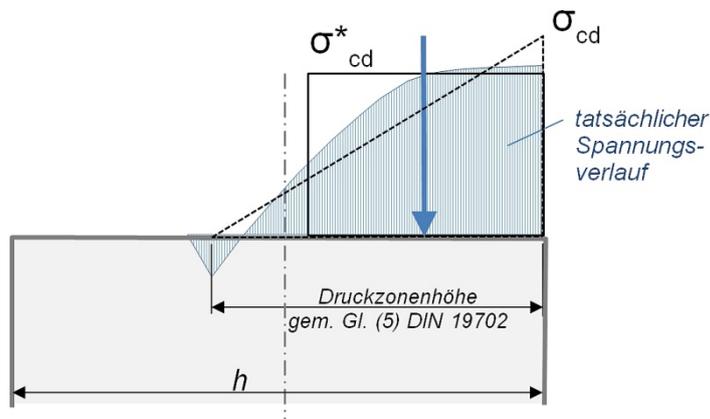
Verteilung der Spannungen an unbewehrten Querschnitten
